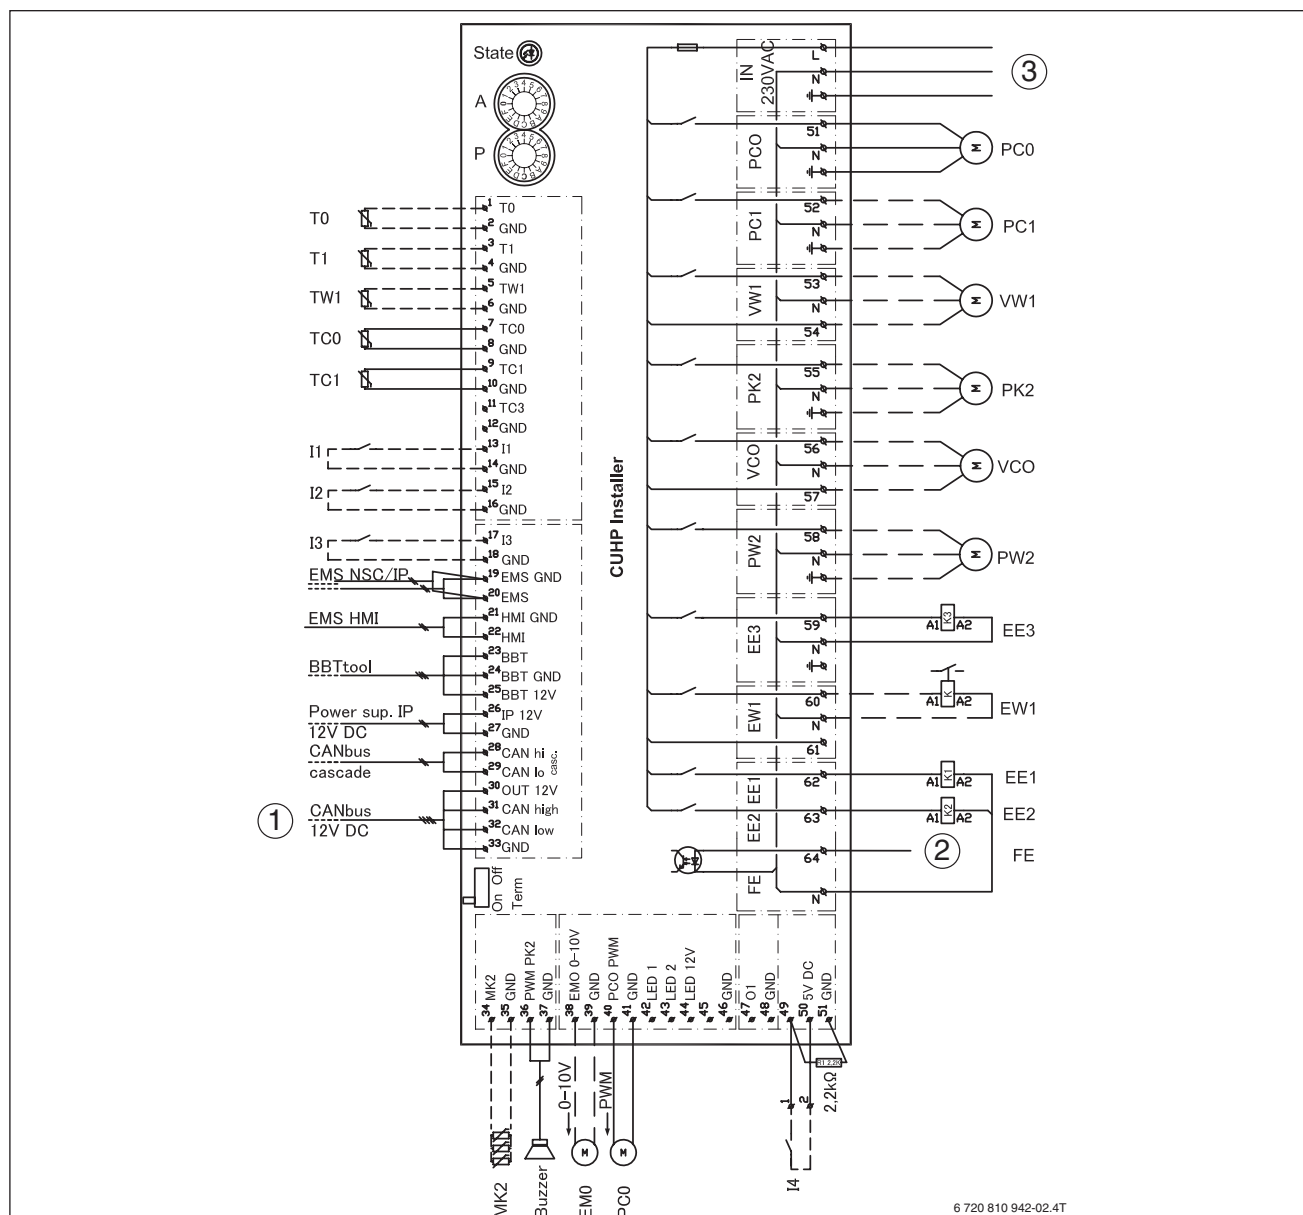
Schemat połączeń modułu instalacyjnego z zaworem mieszającym do pracy dwusystemowej
